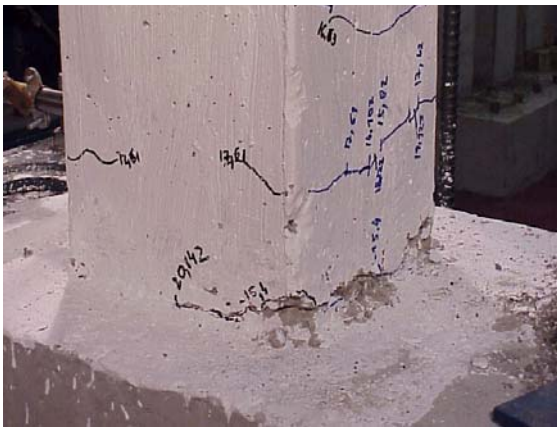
Sistema de reforço aplicado nos pilares ensaiados.
